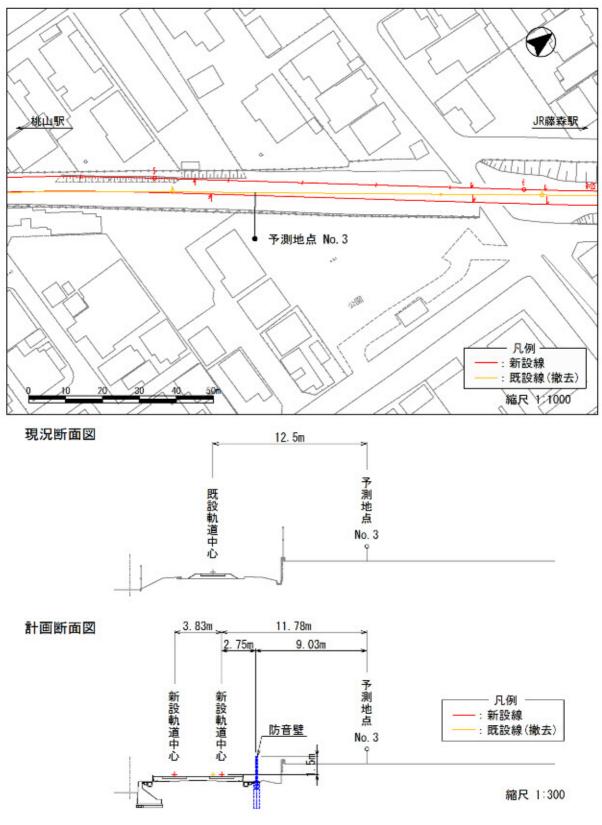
(3) 予測平面·断面図(予測地点 No.3)
